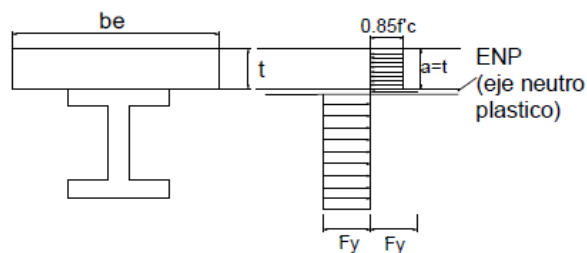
Viga compuesta con ENP en el ala de la sección de acero (Johnston L., 1999)
